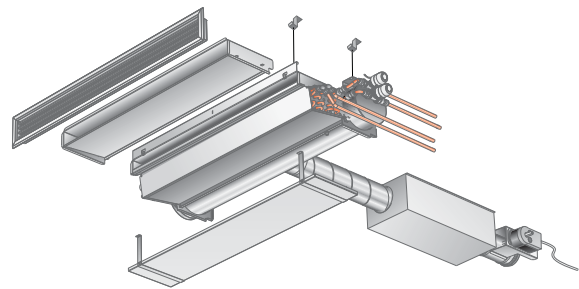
Typeninstallation mit Verlängerungsstutzen
